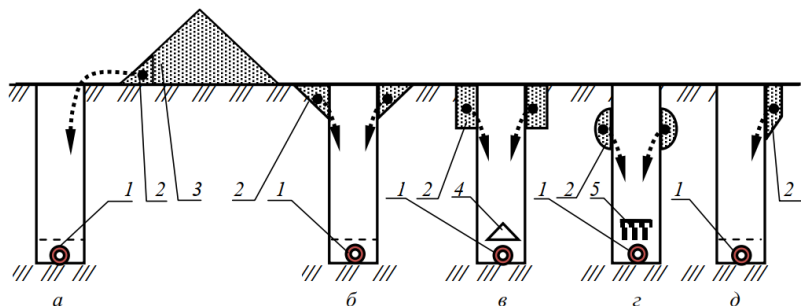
Схемы присыпания дрена: а — с возвратом грунта из кавальера; б — с треугольным обрушением кромок траншеи; в — с прямоугольным обрушением кромок траншеи; г — с подрезанием стенок траншеи; д — с обрушением одной кромки траншеи: 1 — дренажная труба; 2 — грунт присыпки; 3 — кавальер; 4 — пирамидка; 5 — гребенка
